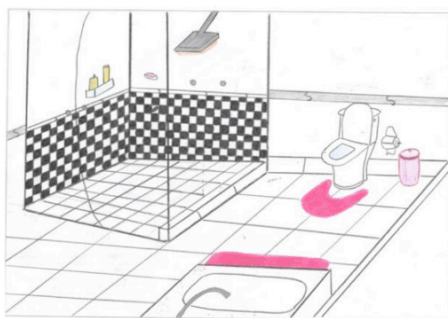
CORTE DO BANHEIRO SUÍTE, 3º PAS
